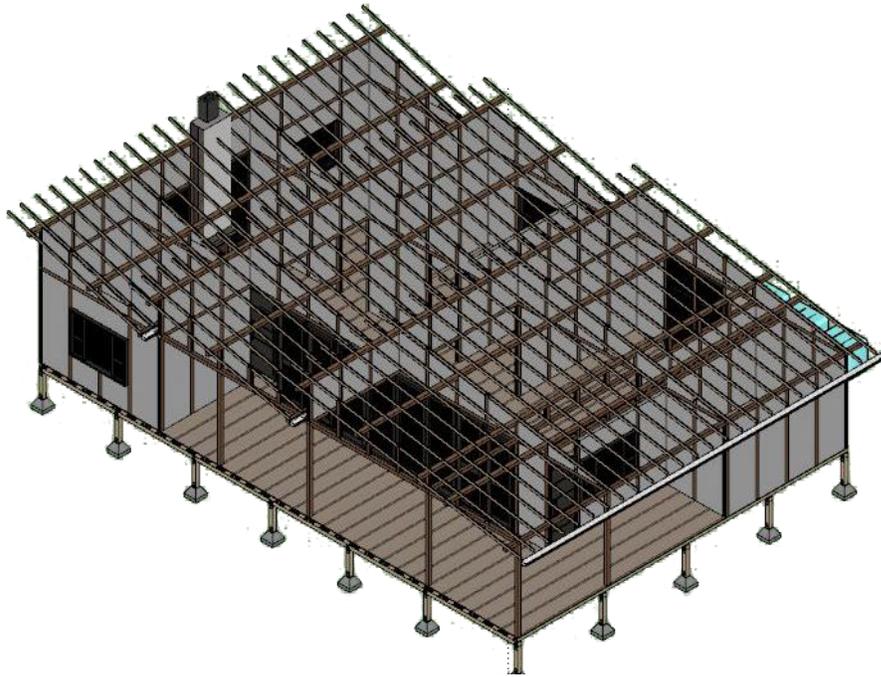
Estructura de la cubierta. Elaboración del autor
